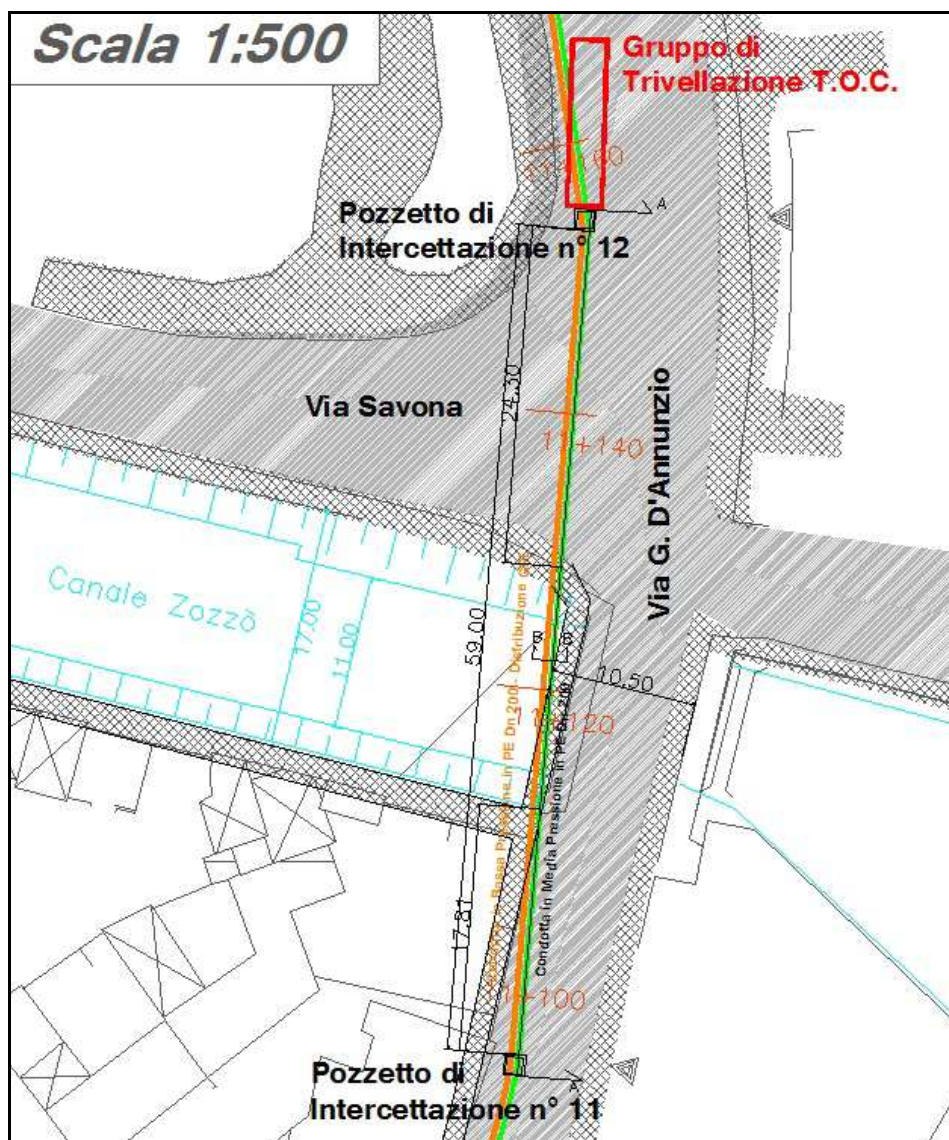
Stralcio planimetrico dell'attraversamento previsto (Elab. I.6).
